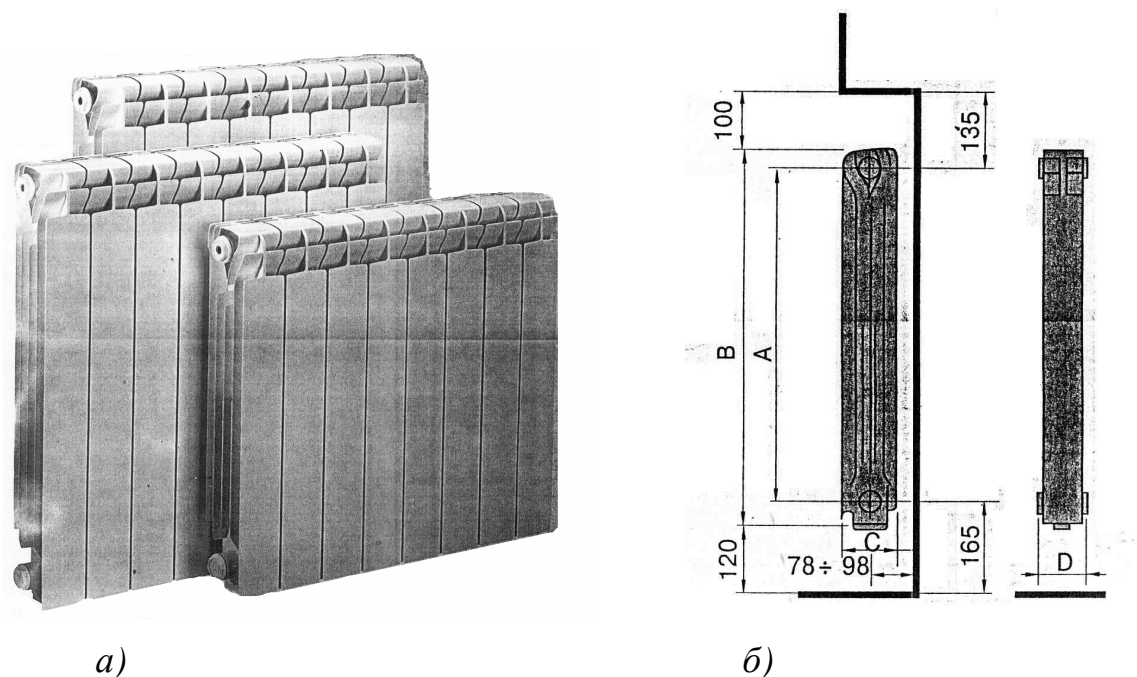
Радиатор “Калидор”: а – внешний вид; б – конструкция и размеры радиатора
